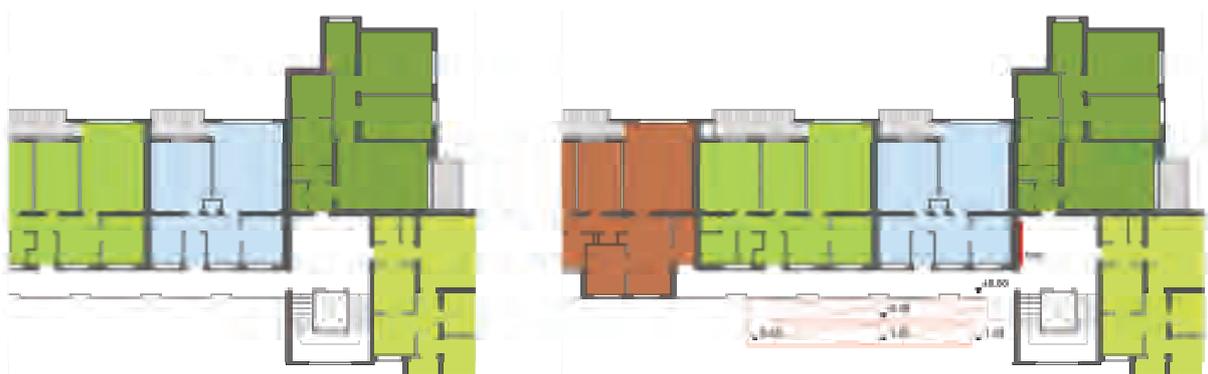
Entwurfsvariante Erschließungsrampe Bestand / Entwurf
